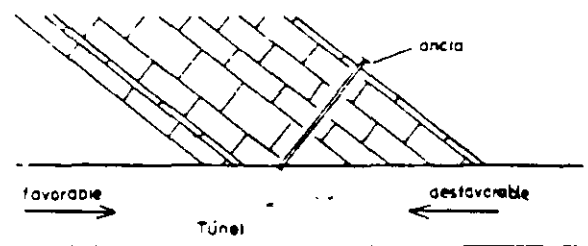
Túnel atravesando cargas inclinadas. La dirección favorable, lo es porque se puede ir anclando cuñas inestables con anterioridad a la excavación.
